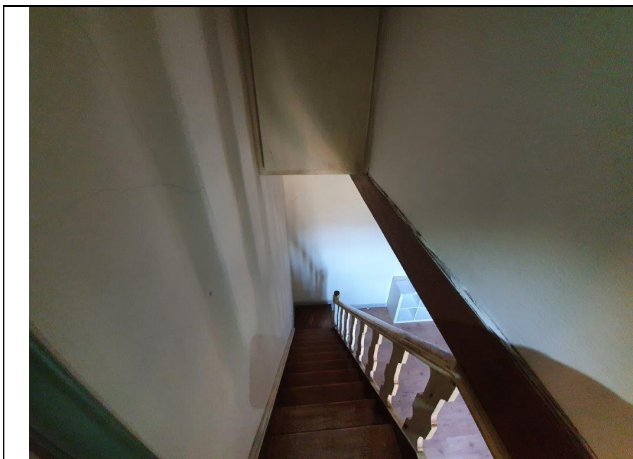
P.1 Scala collegamento camera 1-vano P.2
